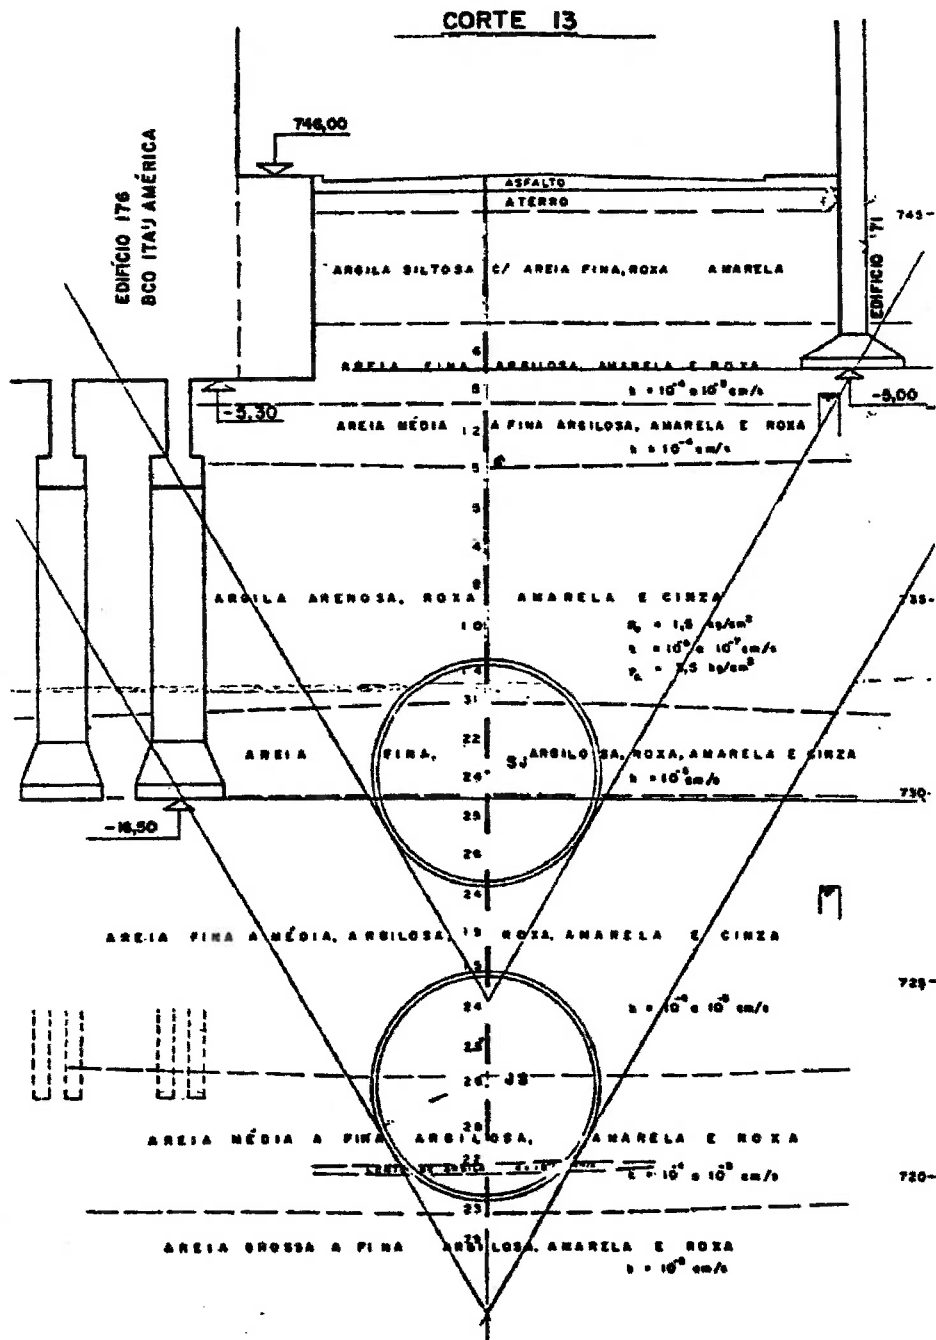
Detalhe do prisma de interferência da escavação.
